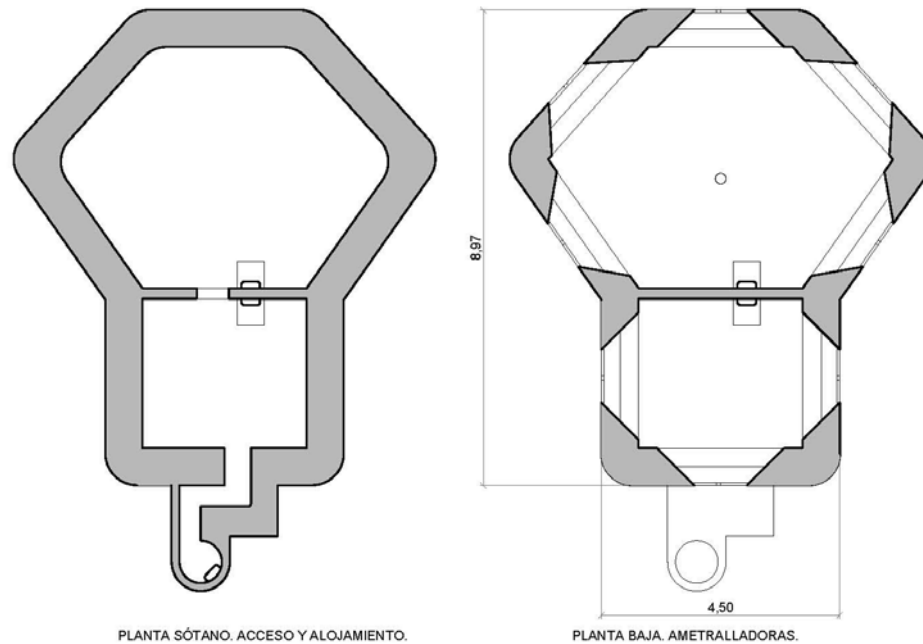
Plano de nido de ametralladoras tipo 3.
